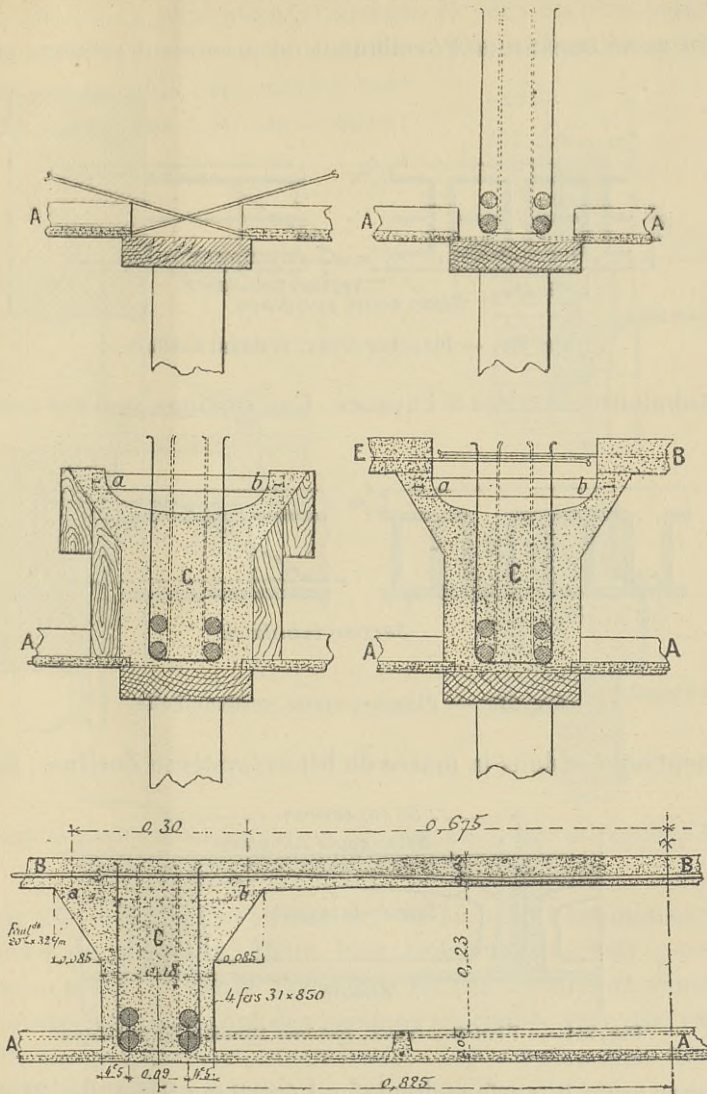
Diverses phases de la construction d'un plancher creux avec hourdis et plaques de plafonnage moulées à l'avance.
